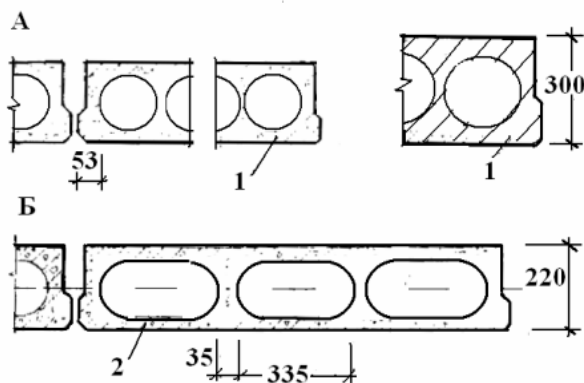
Багатопустотні панелі перекриття: А – з круглими пустотами (1); Б – з овальними пустотами (2)
